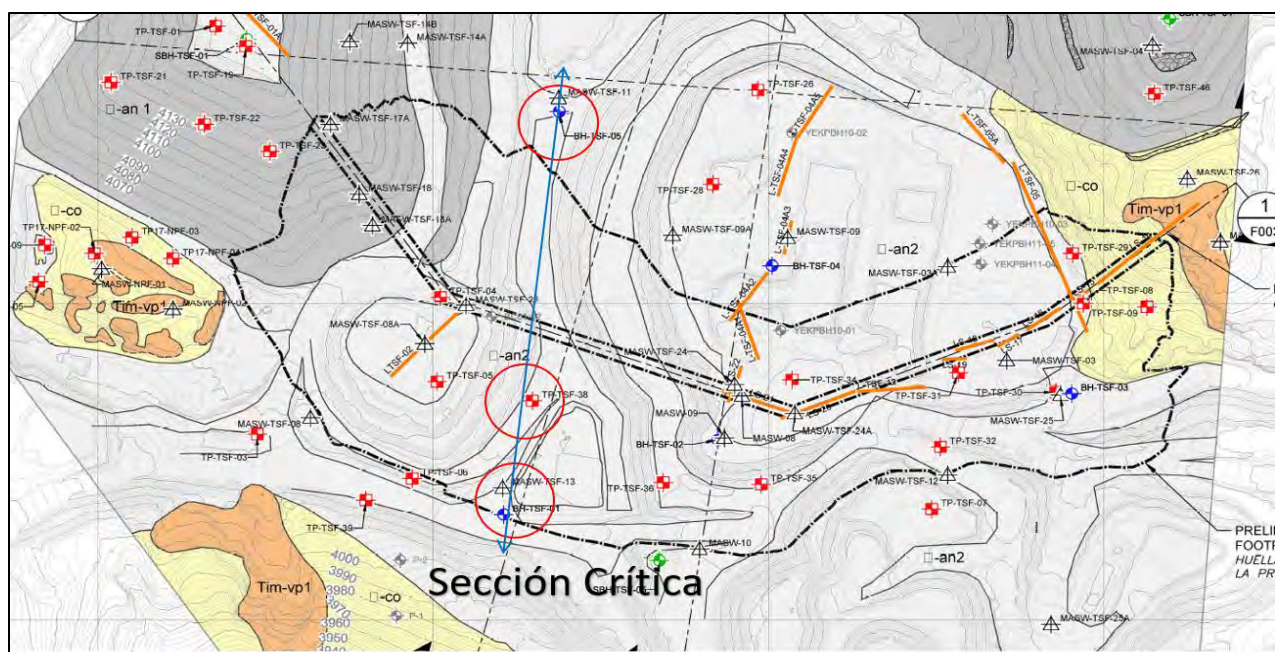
Vista en planta sección crítica y ensayos utilizados (línea azul: eje sección crítica).
